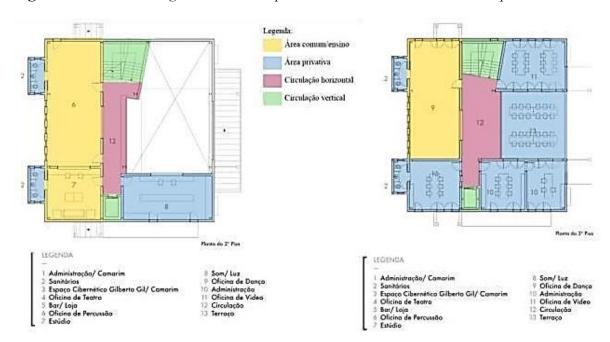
Planta baixa segundo e terceiro pavimentos do Instituto Arte no Dique
